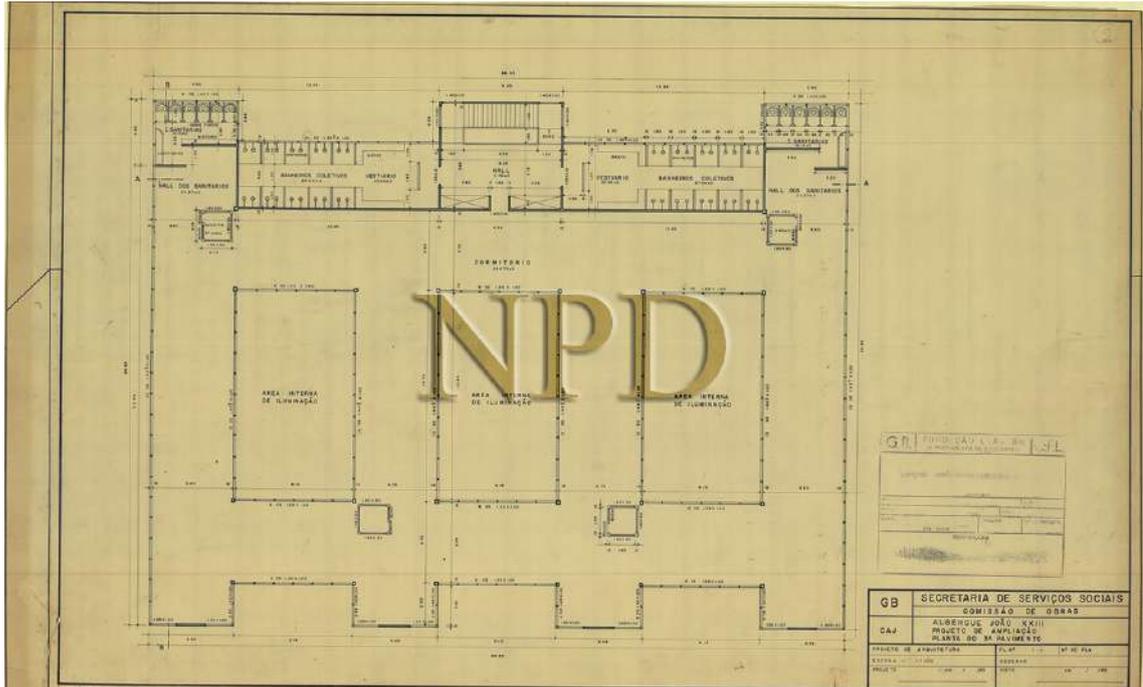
Proposta de acréscimo para o 3º pavimento.
